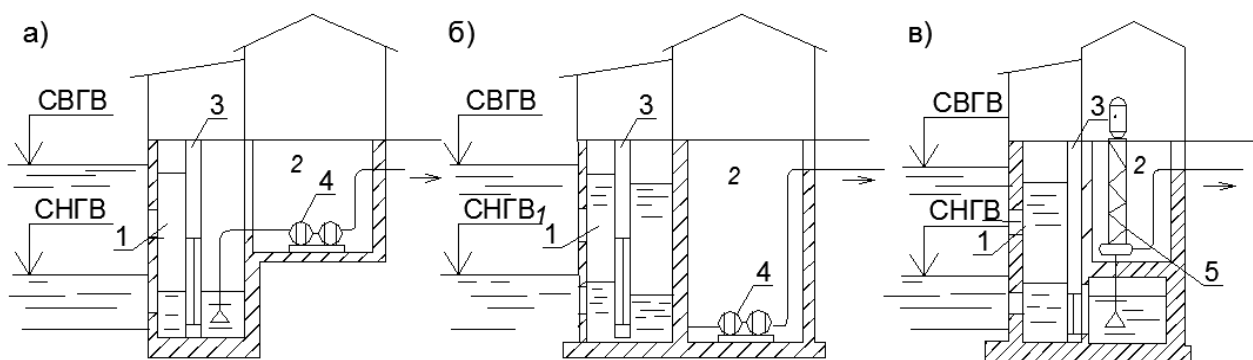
Водоприемник совмещенный с насосной станцией: а – в плотных грунтах; б – в любых грунтах; в – с электродвигателем в верхнем павильоне водоприемника: 1 - водопримное отделение; 2 – насосное помещение; 3 – плоские сетки; 4 – горизонтальный центробежный насос; 5 – вертикальный центробежный насос.
